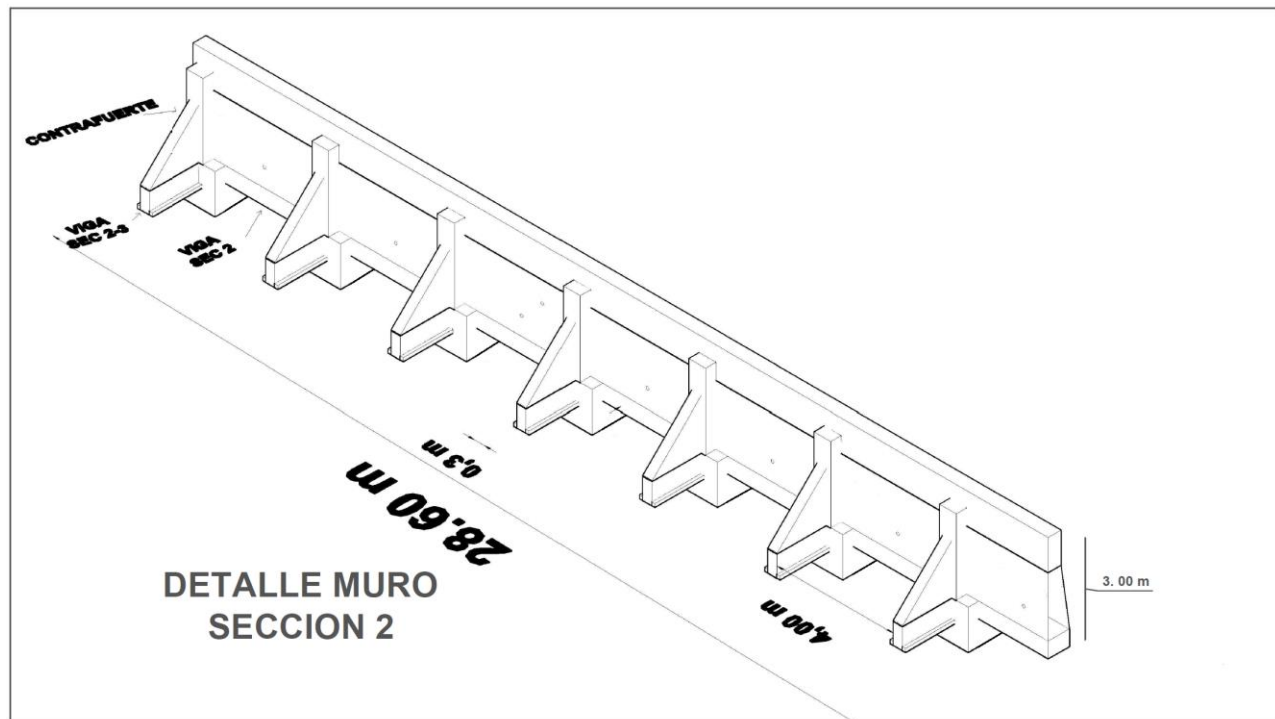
Detalle muro sección 2. Fuente: Plano Muro San Blas
